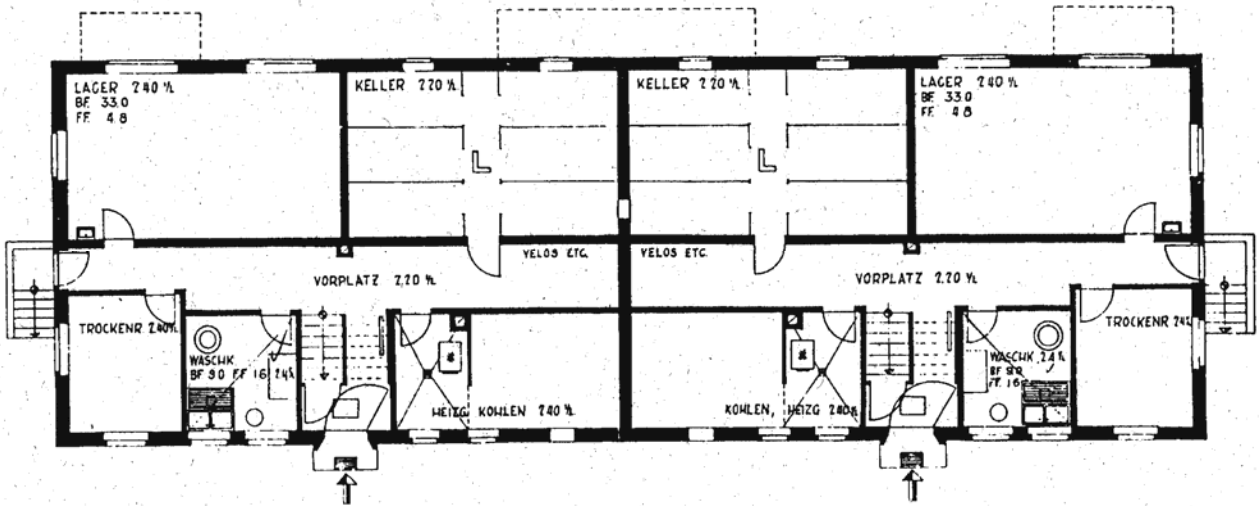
Immeuble Friestrasse 28/30 - Plan du sous-sol
